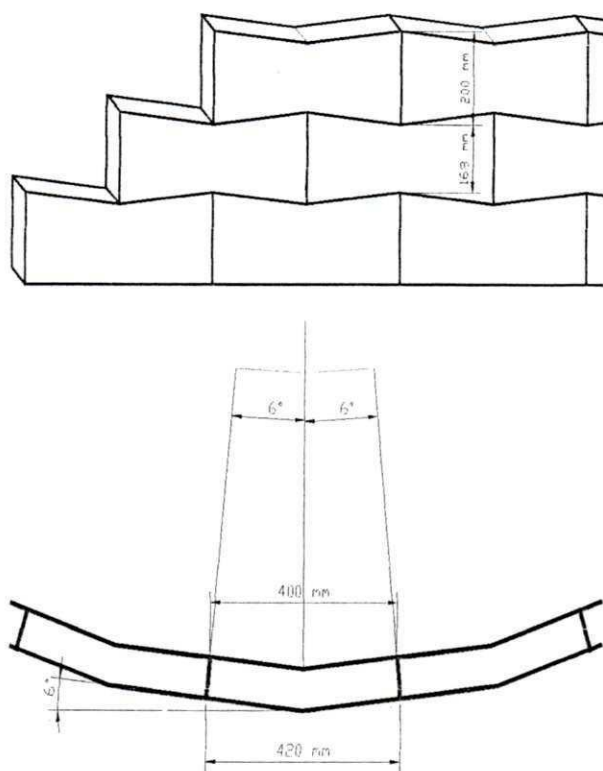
Blocos de concreto para silos circulares de alvenaria sem reforço estrutural
